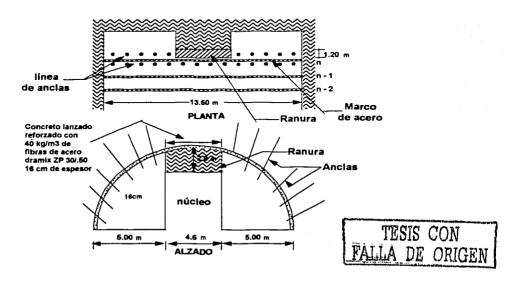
Excavación de la porción superior central y colocación de concreto lanzado en la clave.
